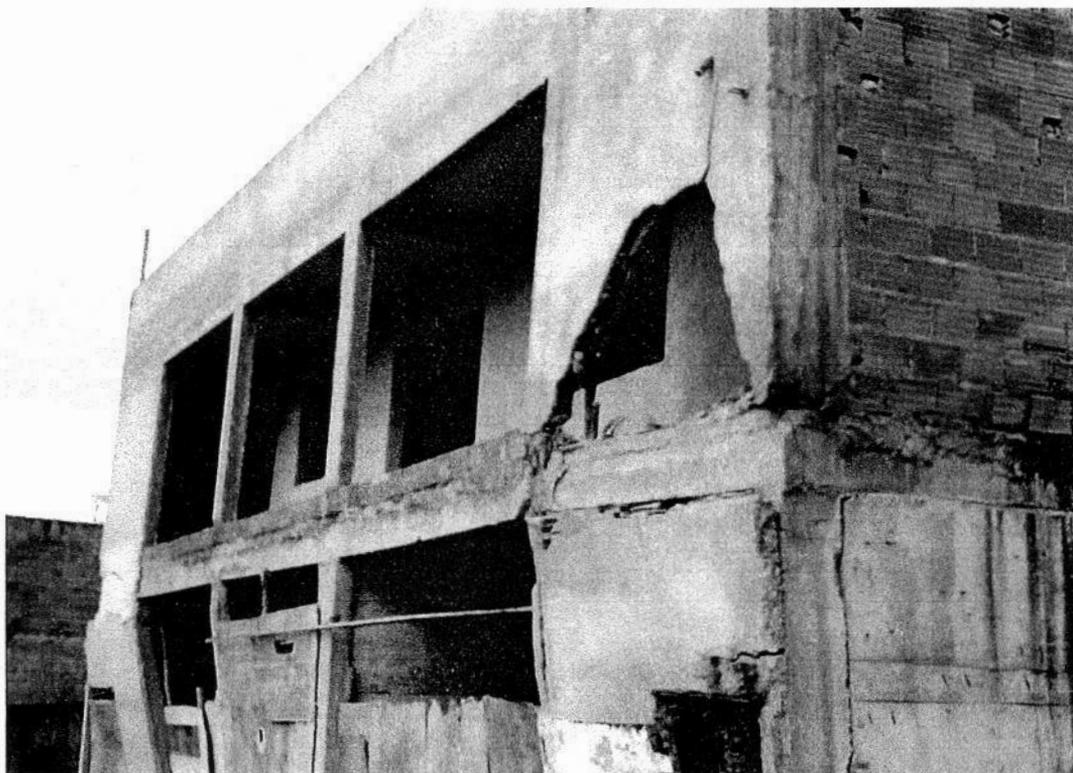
Rachaduras na fachada em 23/09/2022, casa s/n
